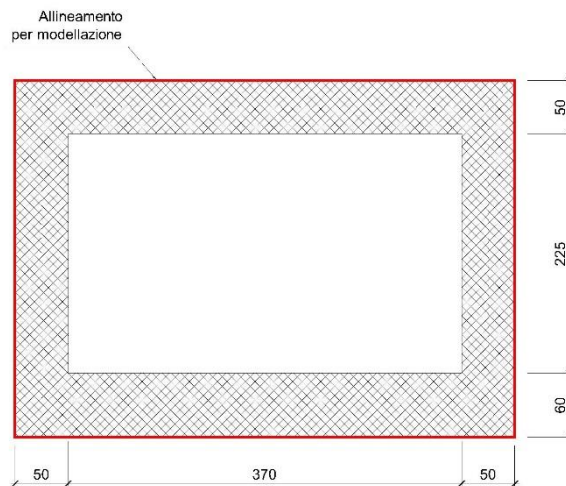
Sezione tipica di progetto e schematizzazione di calcolo
